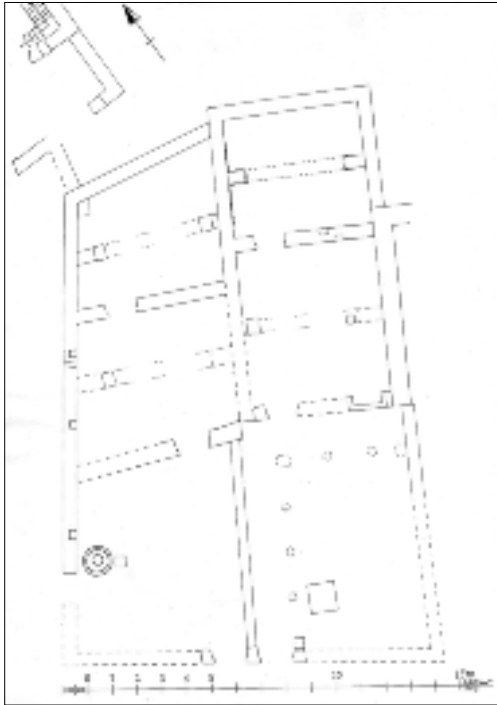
Karakabaklı Haus C. Grundriss
